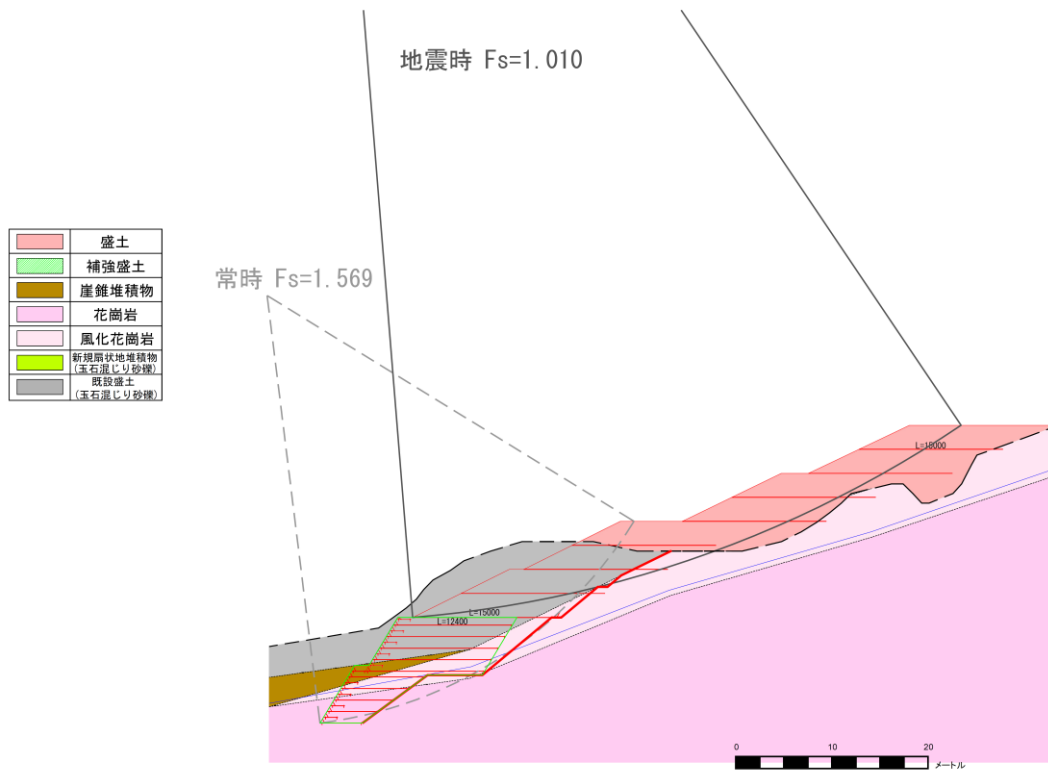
(3) 土地の安定性の検討断面図(1-3)
